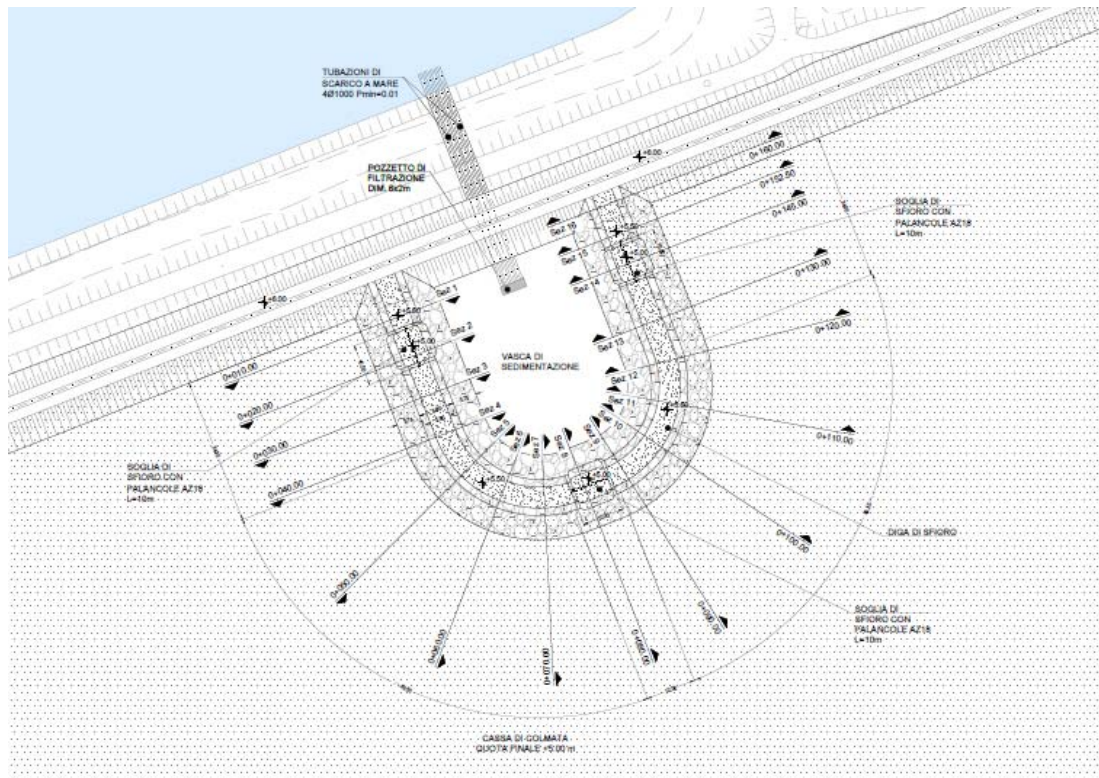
t: Cassa di Colmata Esistente – Dettaglio Planimetrico di Diga di Sfiro e Vasca di Sedimentazione
